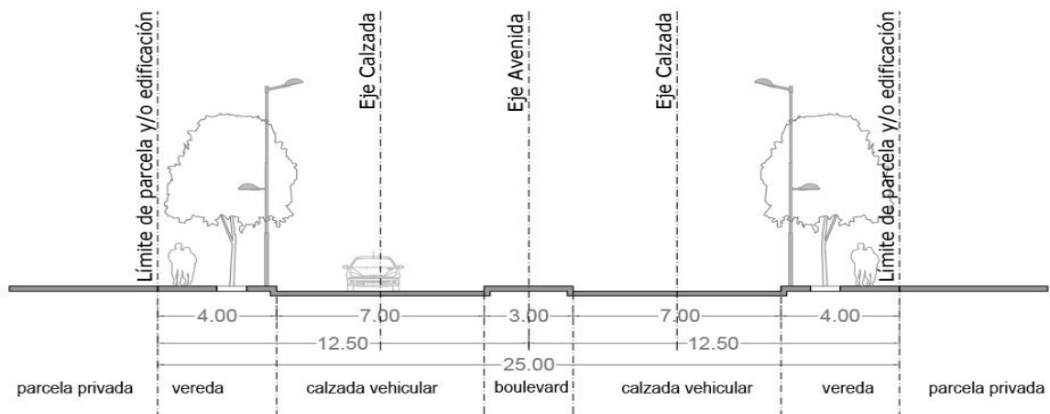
Sección transversal de Vías Avenidas Tipo 5.
